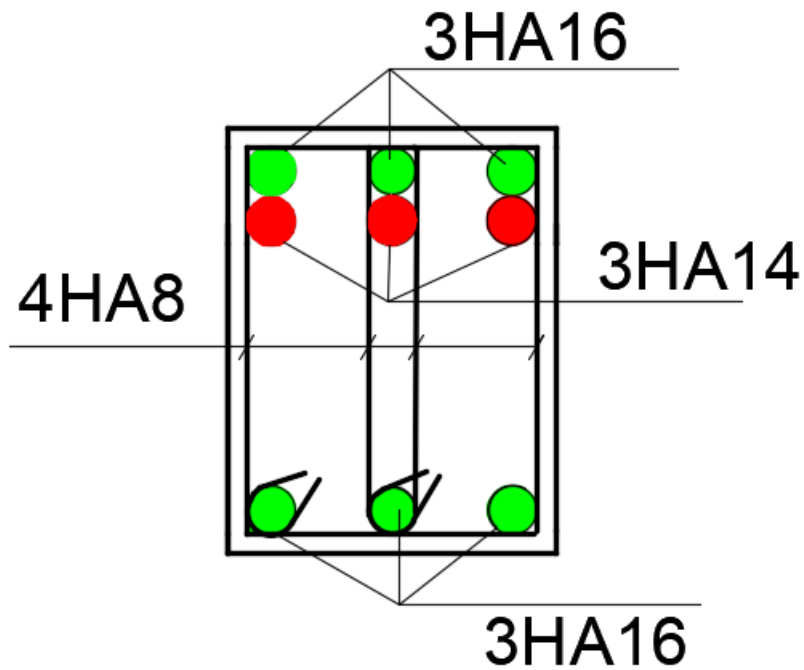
Ferrailage de la poutre secondaire.
